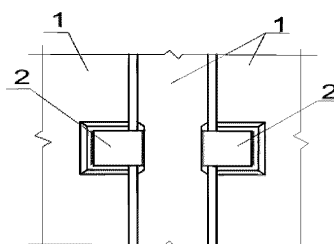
Т-образное соединение панелей. Вид сбоку. Сваренные между собой закладные детали, заанкеренные в теле панелей: 1 – стеновые панели; 2 – соединительные пластины, приваренные к закладным деталям панелей
